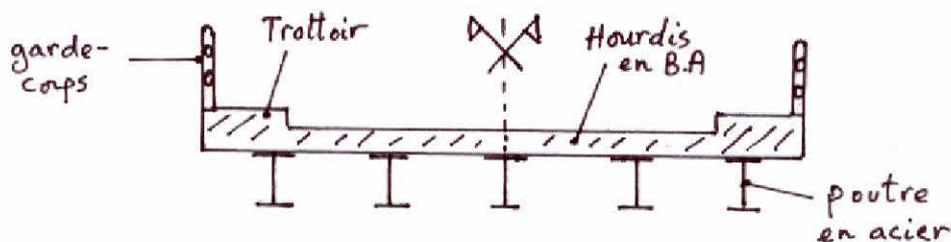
Coupe transversale du tablier d'un pont mixte (acier-béton).
